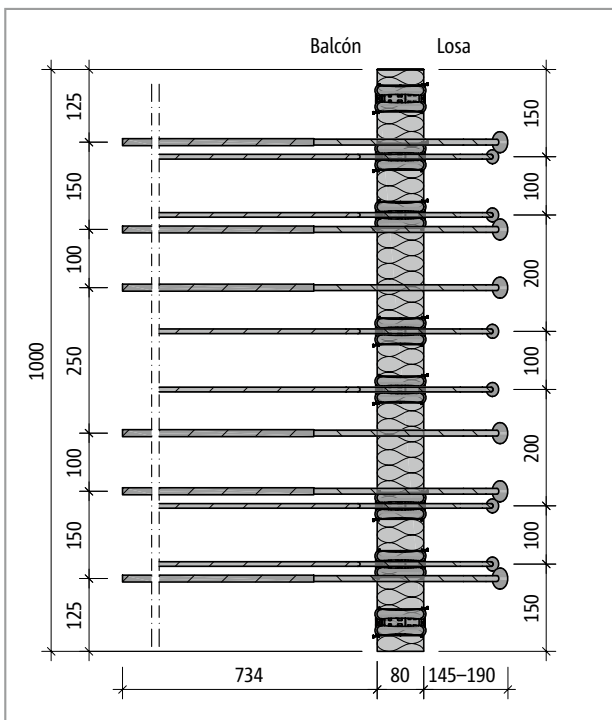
Schöck Isokorb® T tipo K-O-M2: Plano del producto
